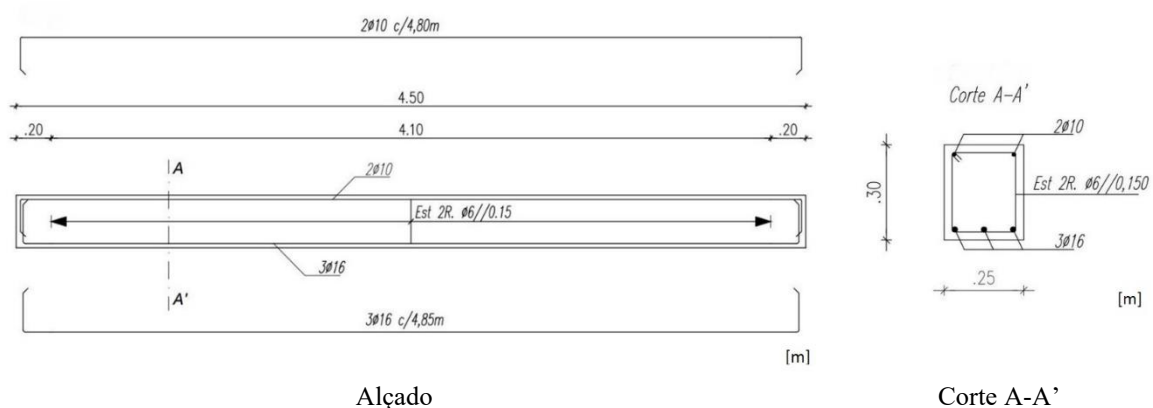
Pormenorização do betão armado da viga de betão armado [4].
